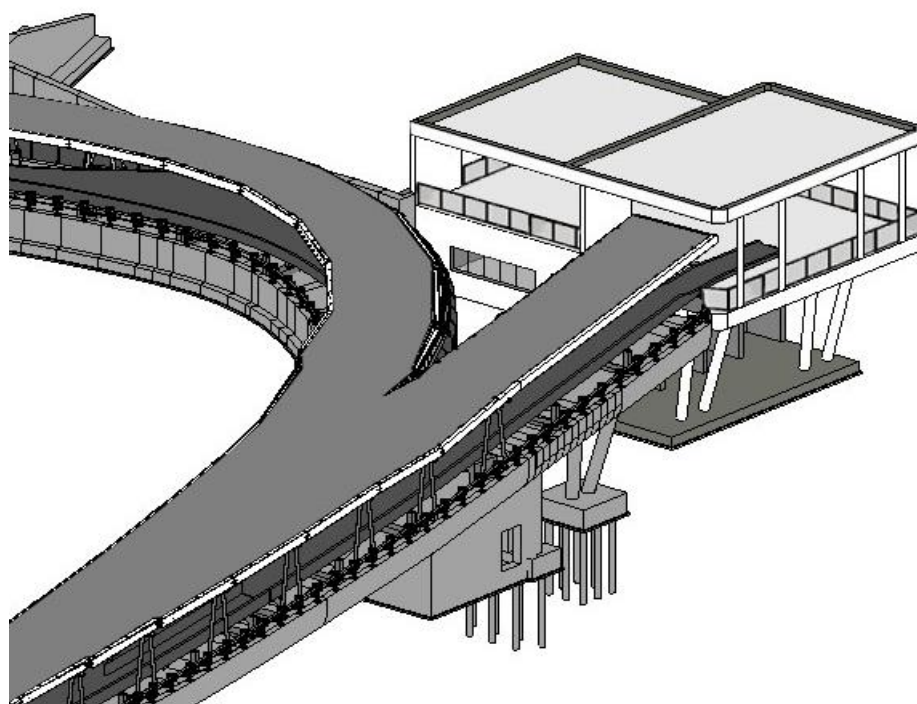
Vista dell’edificio B nell’aggiornamento del progetto
